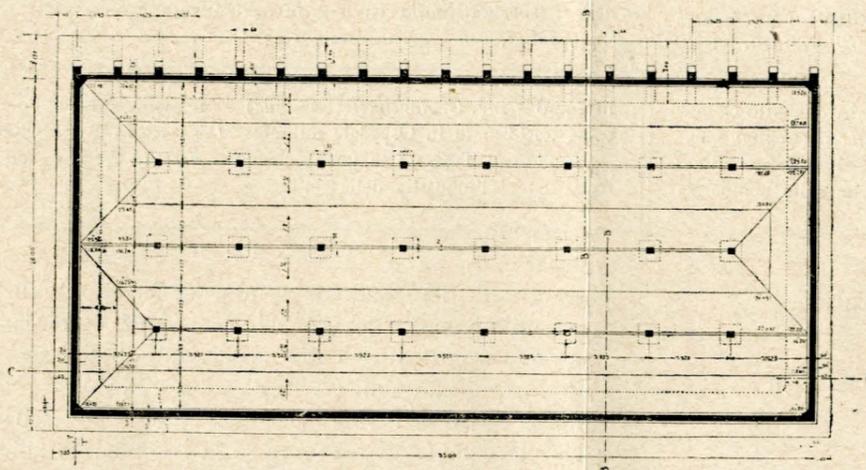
Pianta del Serbatoio Inferiore (2800 mc.) a S. Maurizio (Pinerolo).
